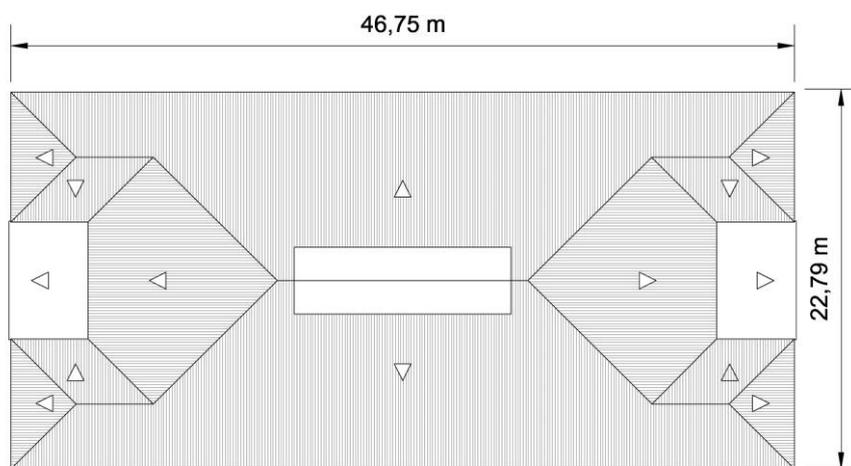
Dimensiones de planta Colegio Público Max Aub
